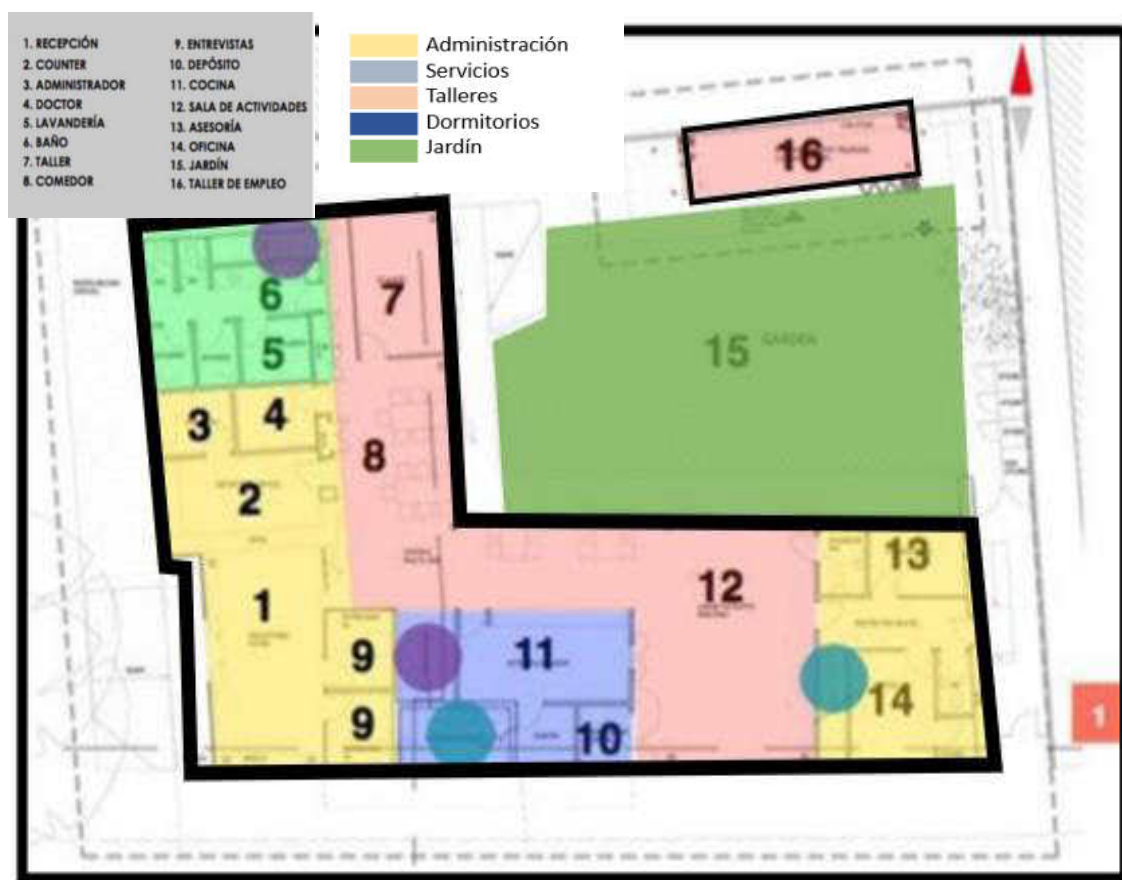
planimetría 1ª piso fuente:Pag. Web (centro Redbridge – Inglaterra)
